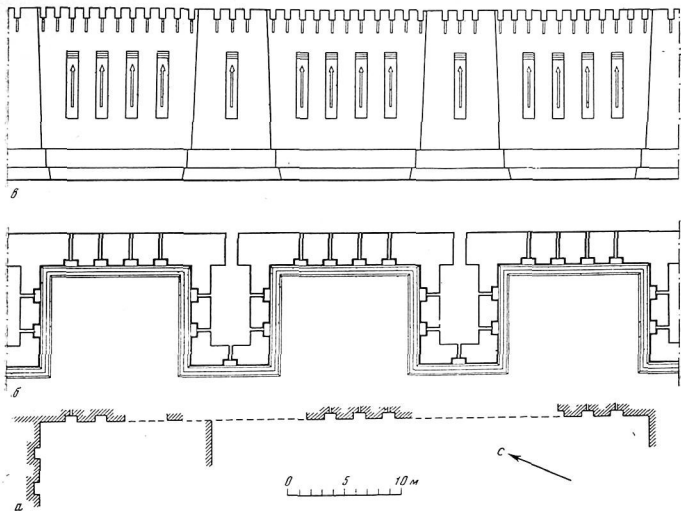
Крепостная стена периода I. Фрагмент фасада а — участок зачатки внешнего контура стены на склоне западного вала (между первой и четвертой башнями); б — план этого участка (реконструкция); в — фасад (реконструкция)
